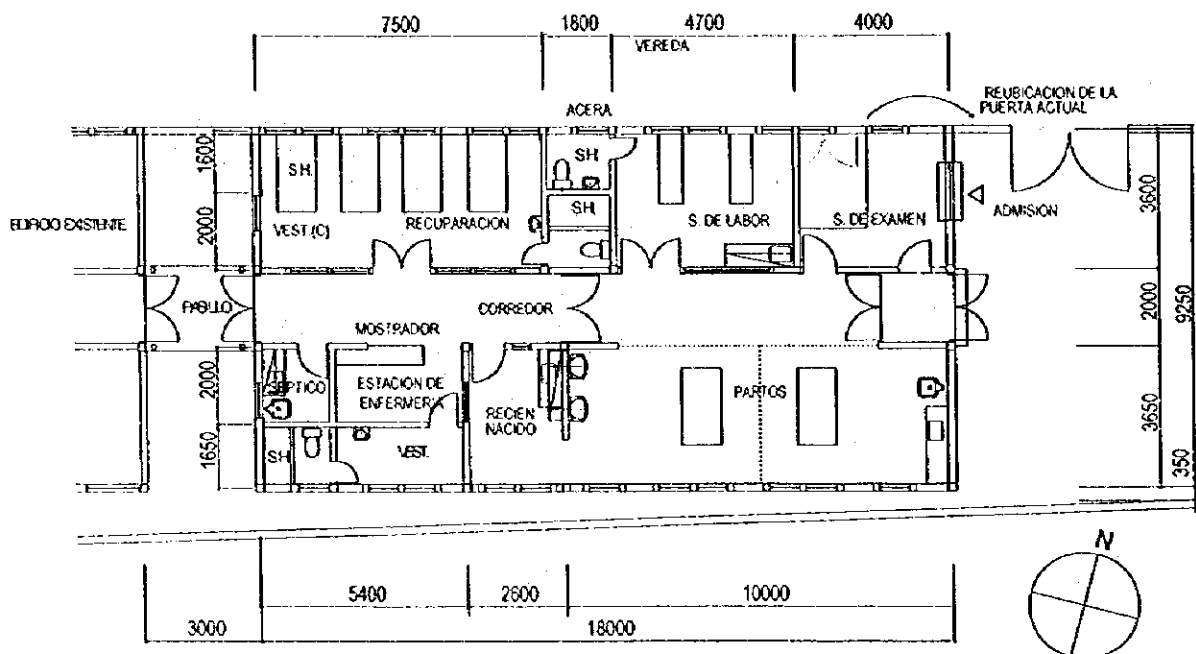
Plano de planta del pabellón obstétrico del C.S. Piedra Liza
